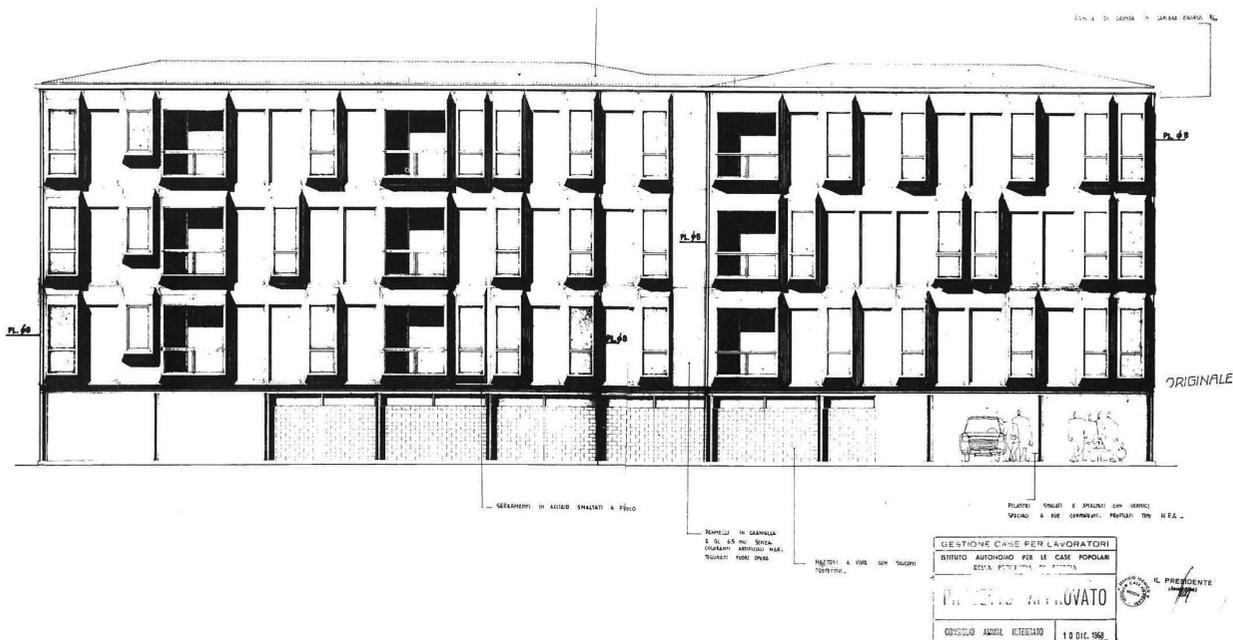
Prospetto del Quartiere di via Collebeato, Brescia (fonte: Archivio ALER Brescia)
